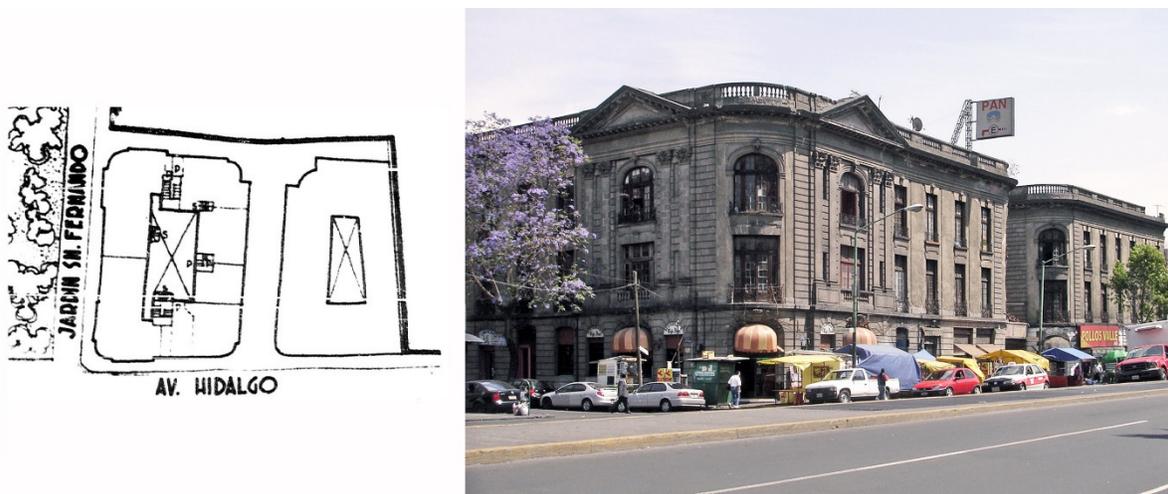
Vista de la fachada en 2008 y planta de conjunto del edificio “San Fernando”. En la fotografía se aprecia la composición académica de la fachada, así como su proporción horizontal más que vertical fruto de tener sólo tres niveles; esta fue una característica común en los edificios de apartamentos en la Ciudad de México en este periodo.
